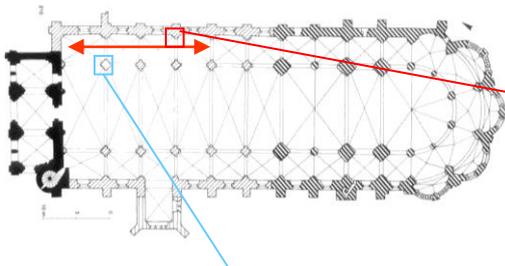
Première pile nord de la nef, reconstruite en 1468.
